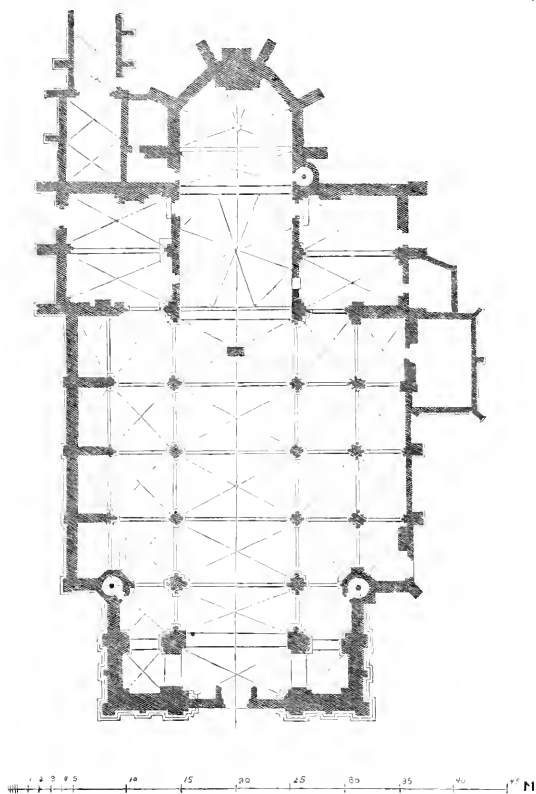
Grundriss der Thomaskirche in Straßburg.
